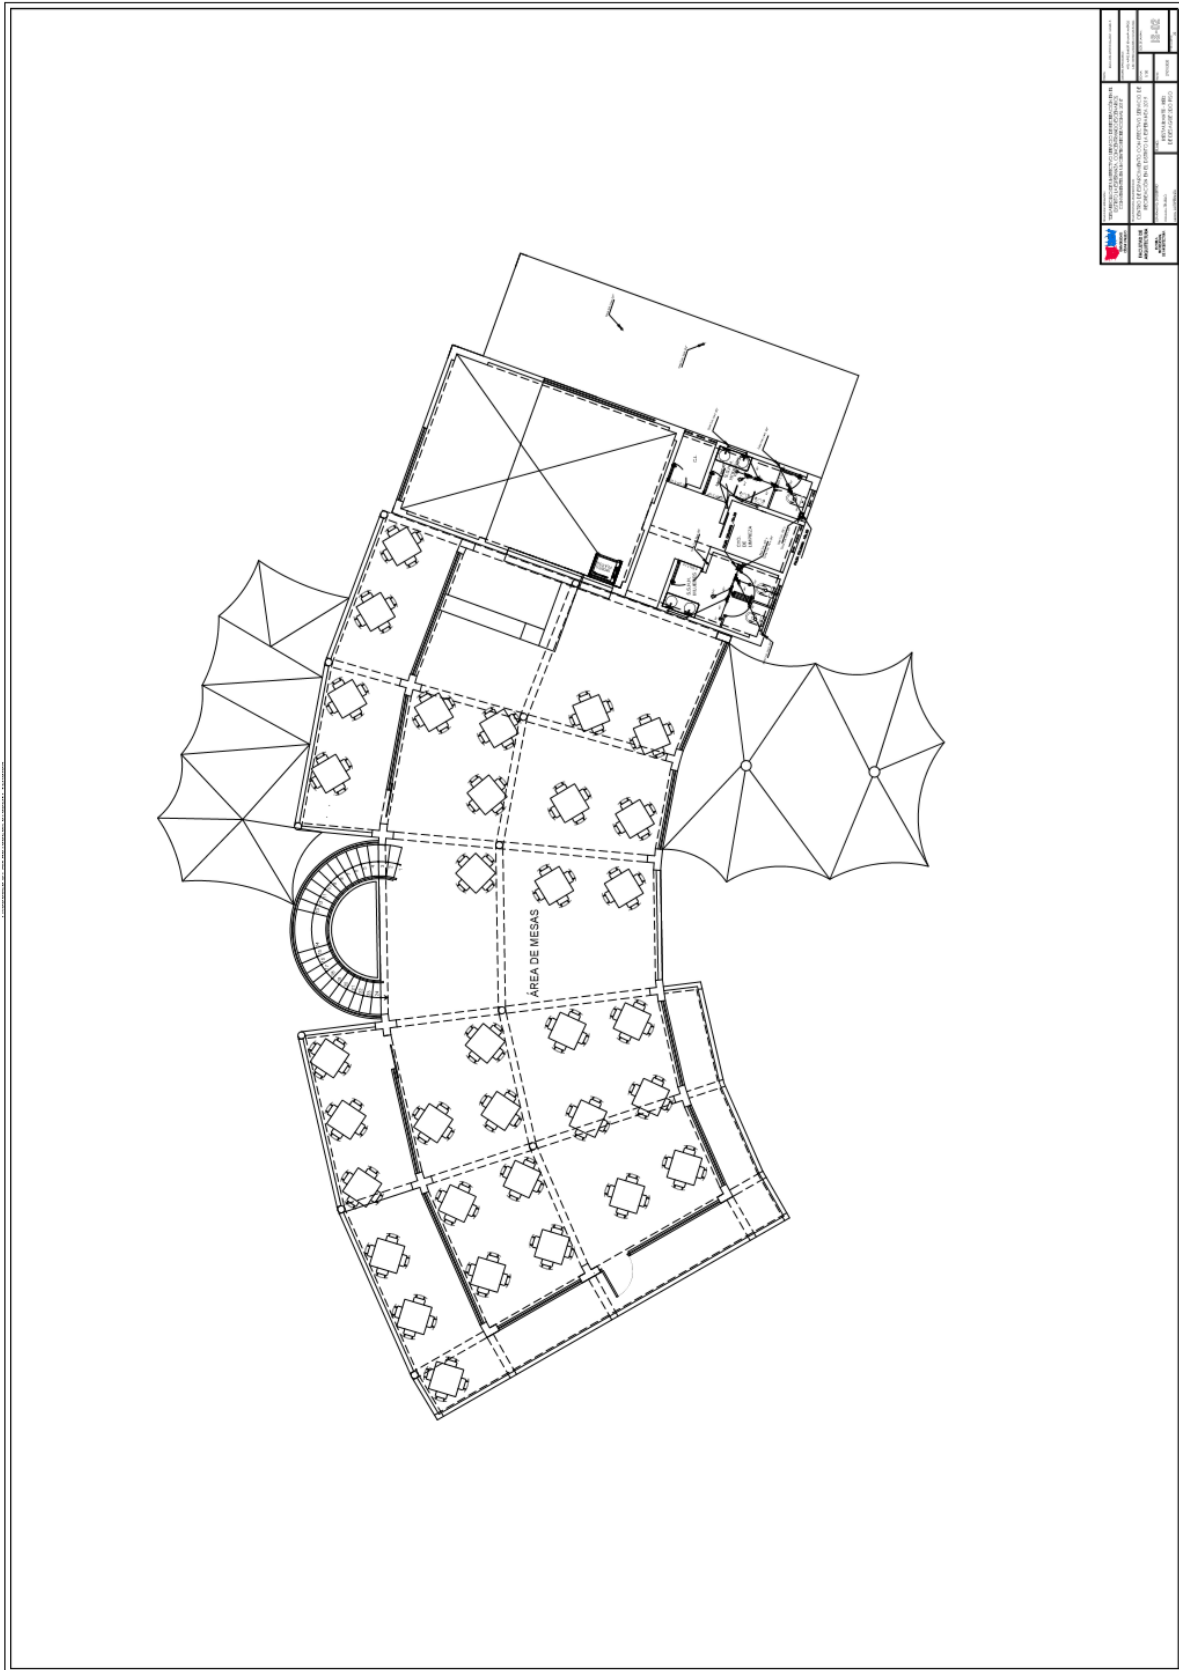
Plano de Desagüe Restaurante 2do piso. Elaboración propia.
